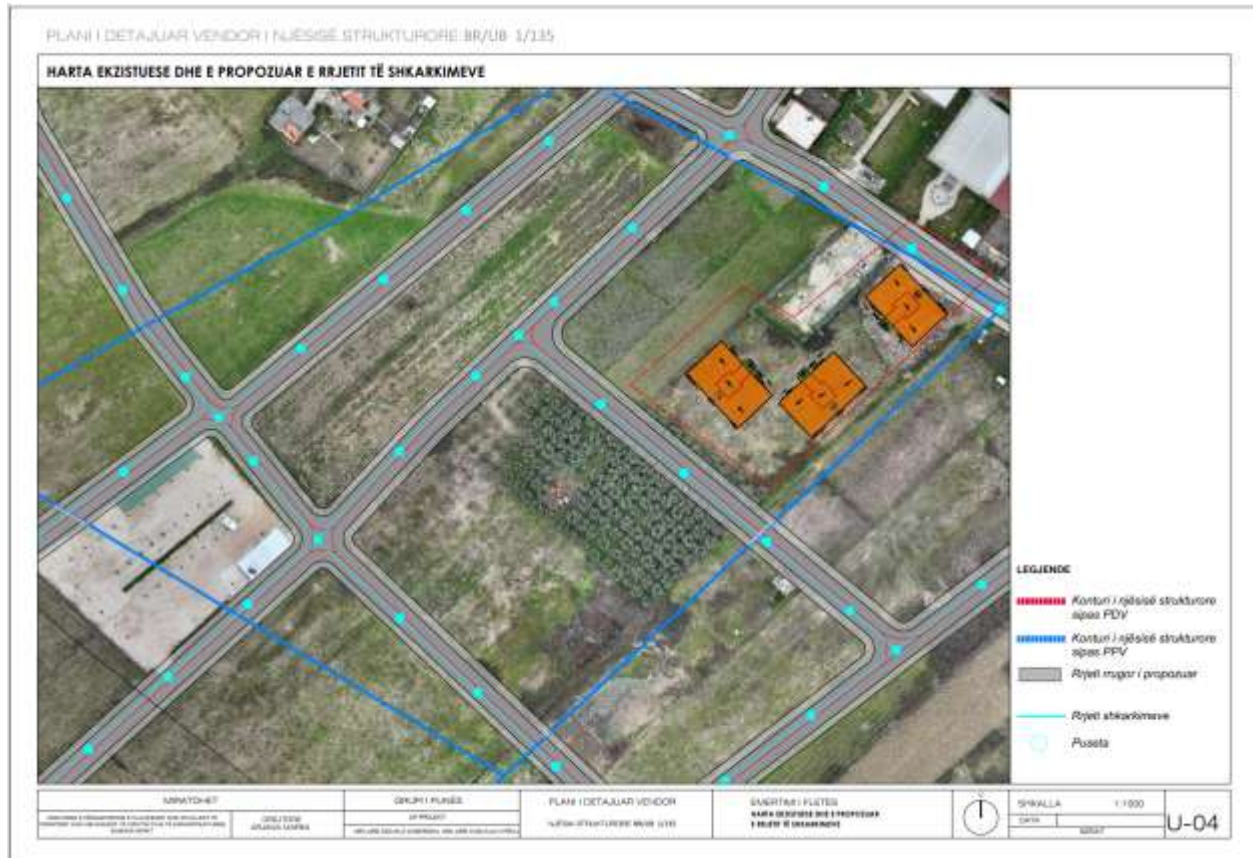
Skema e propozuar e rrjetit të shkarkimeve
